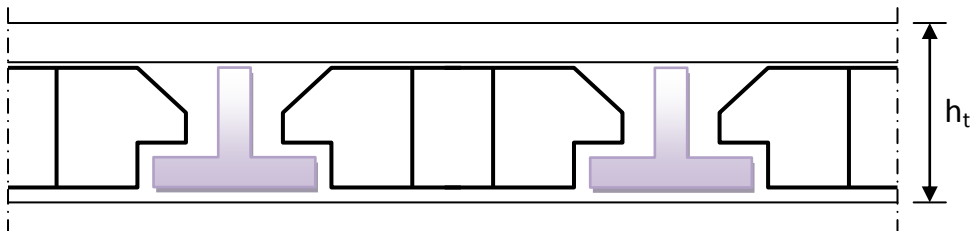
coupe transversale d'un plancher à corps creux »
